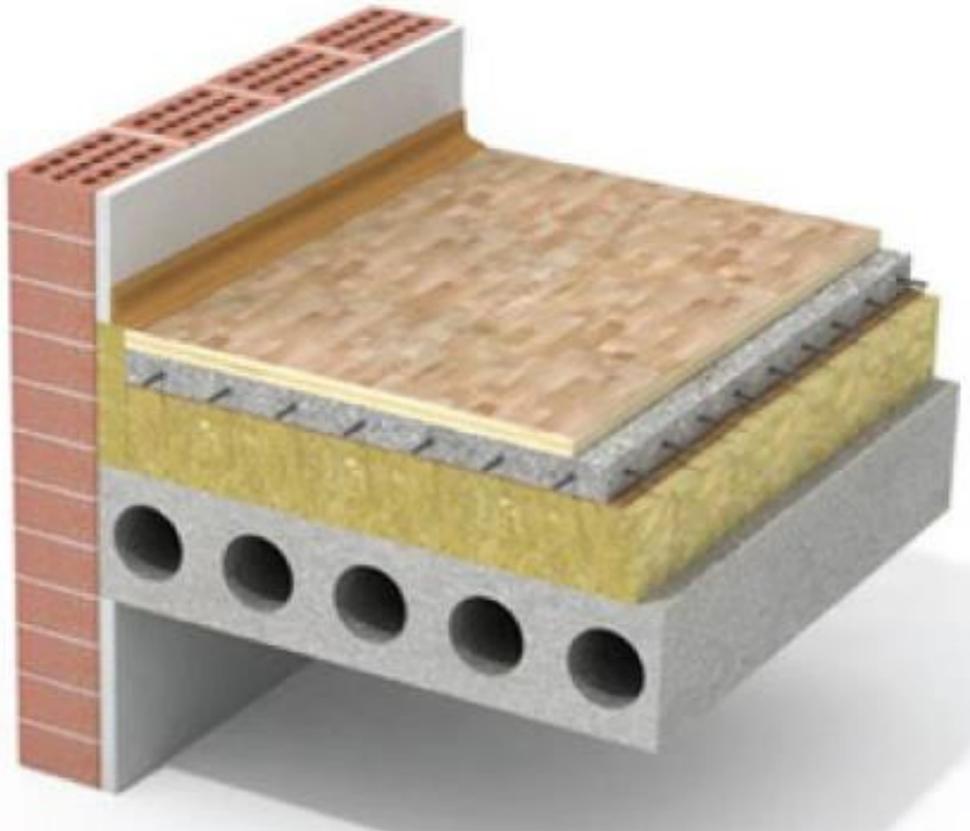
Утеплення мінеральною ватою з покриттям з бетону
